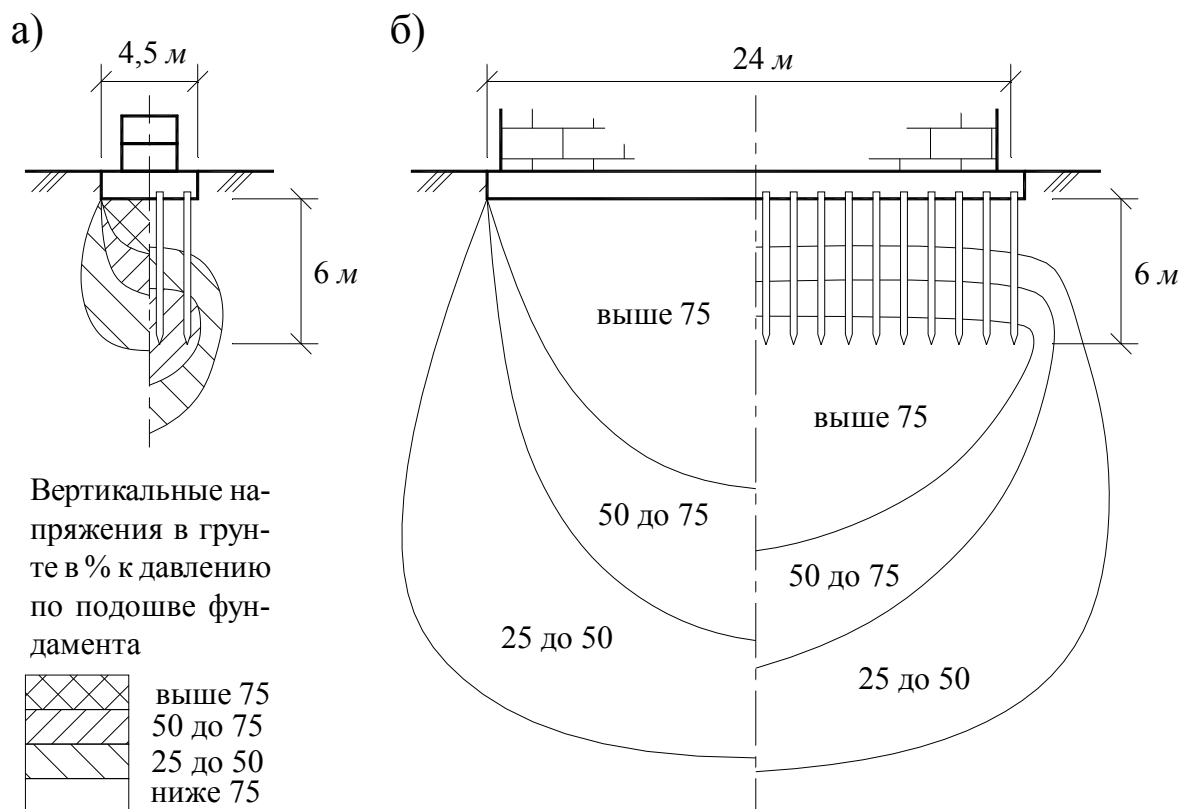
Вертикальное давление в грунте под фундаментами на висячих сваях по К. Терцаги [280]: а — при небольшой ширине фундамента по сравнению с длиной свай; б — при большой ширине фундамента
